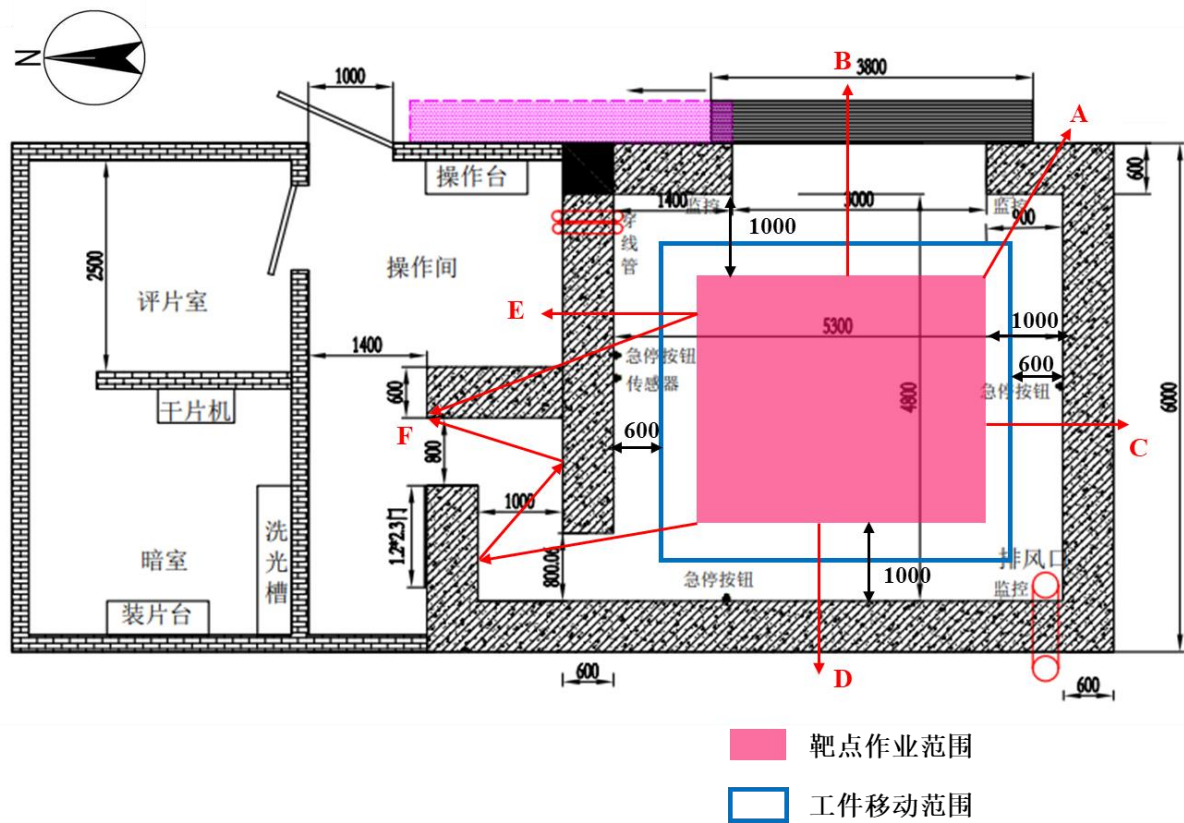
本项目探伤室预测点位平面示意图（单位：mm）
